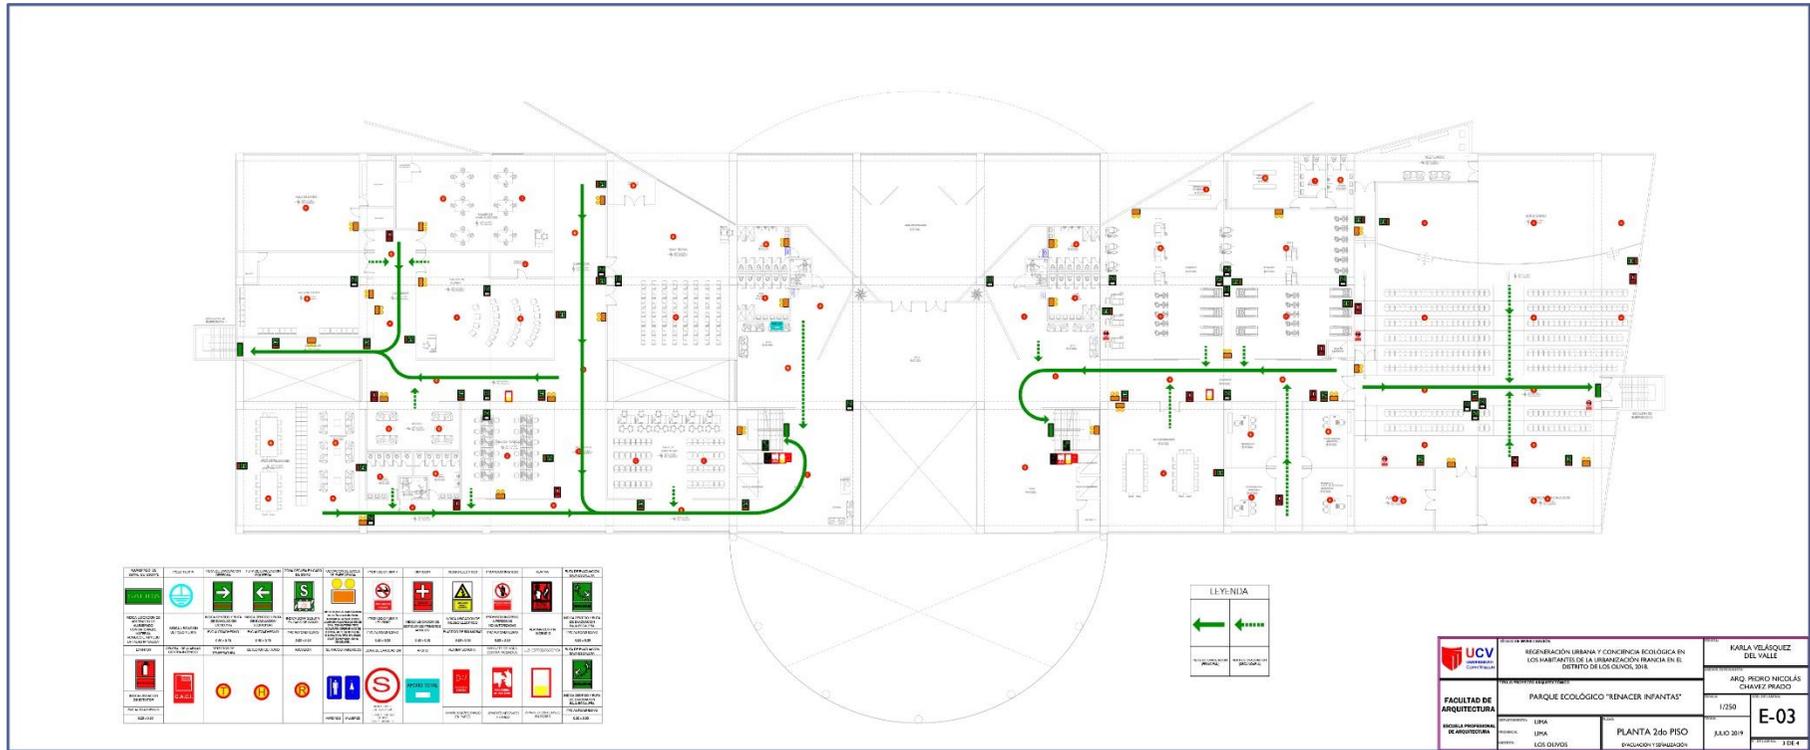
Plano INDECI Planta 2do Piso. Elaboración propia
